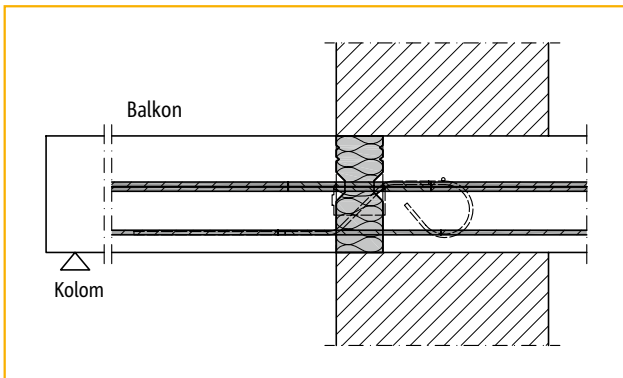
Bovenkant vrij uitkragend balkon met Schöck Isokorf® type K en EQ-module
